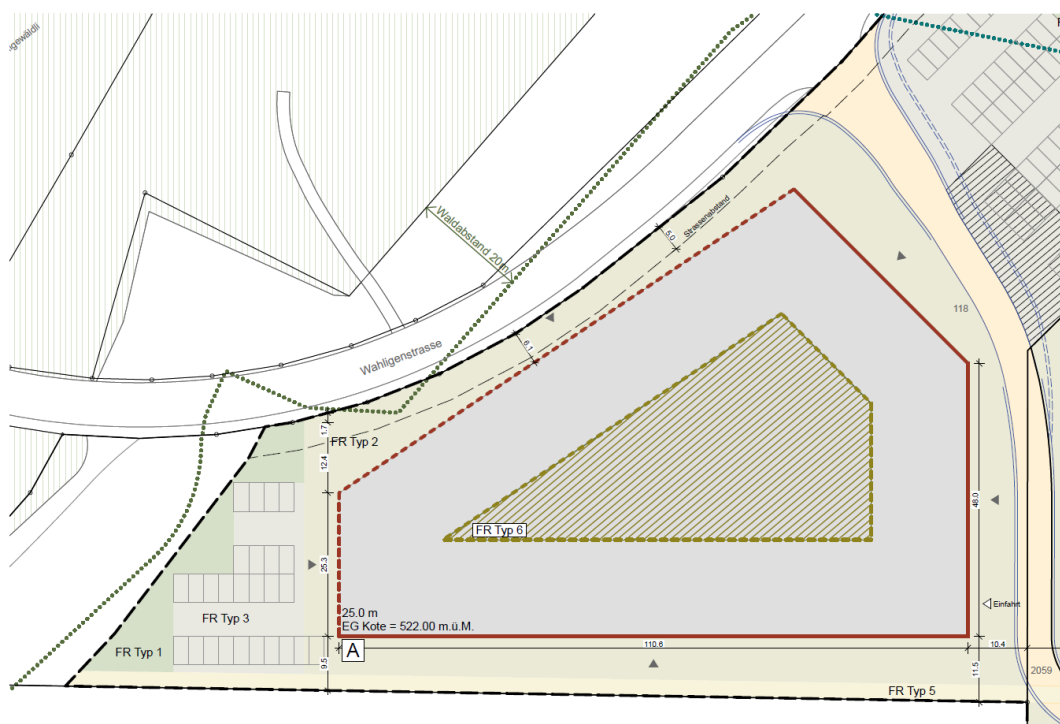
Waldabstand zwischen nächstgelegener Baulinie und Waldrand
